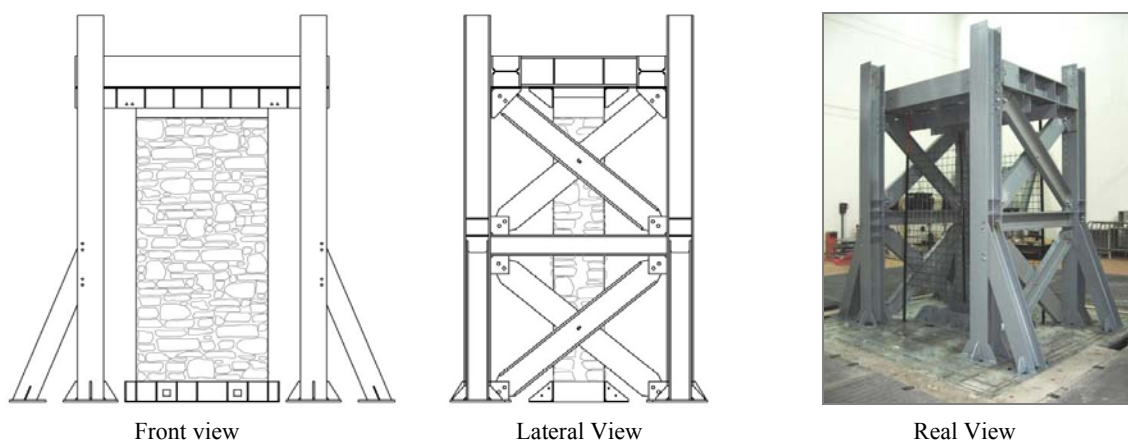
Geometria del telaio di acciaio utilizzato nelle prove dinamiche.
